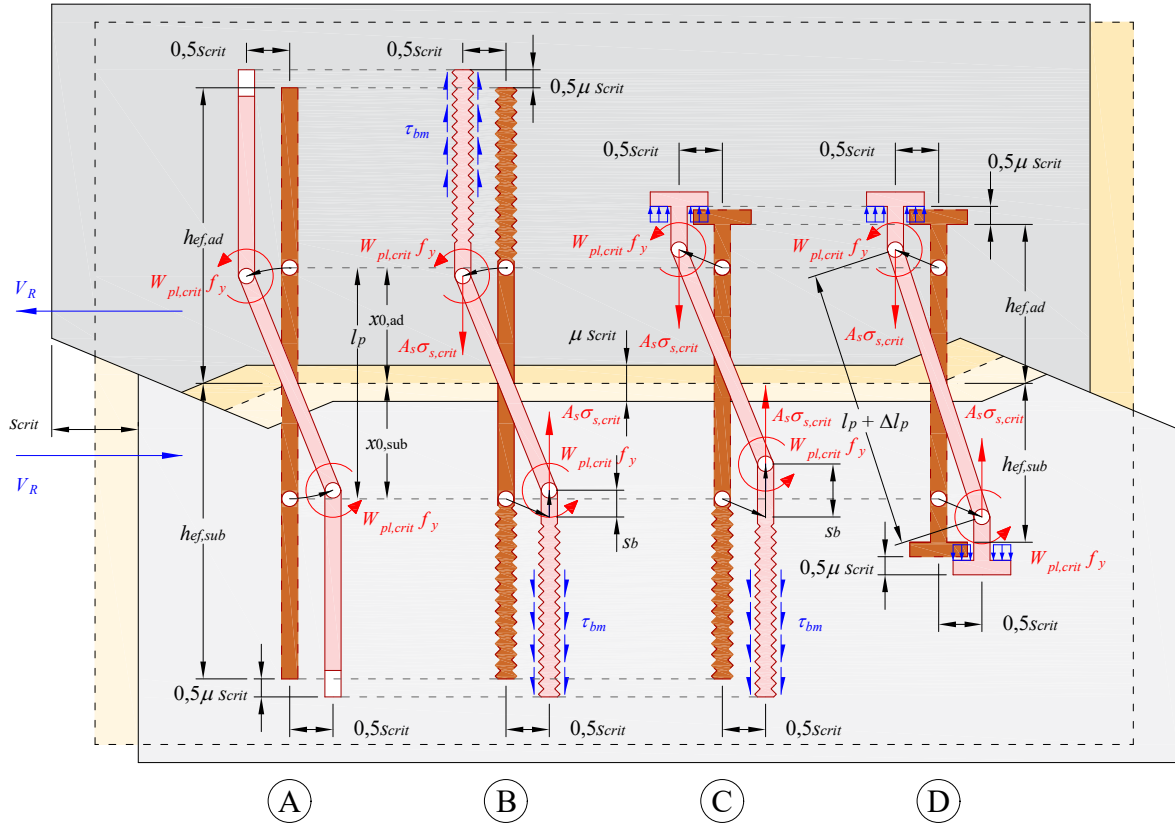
Representação dos quatro tipos de restrição axial para efeito de ferrolho em armaduras a atravessar a interface entre camadas de betão.
